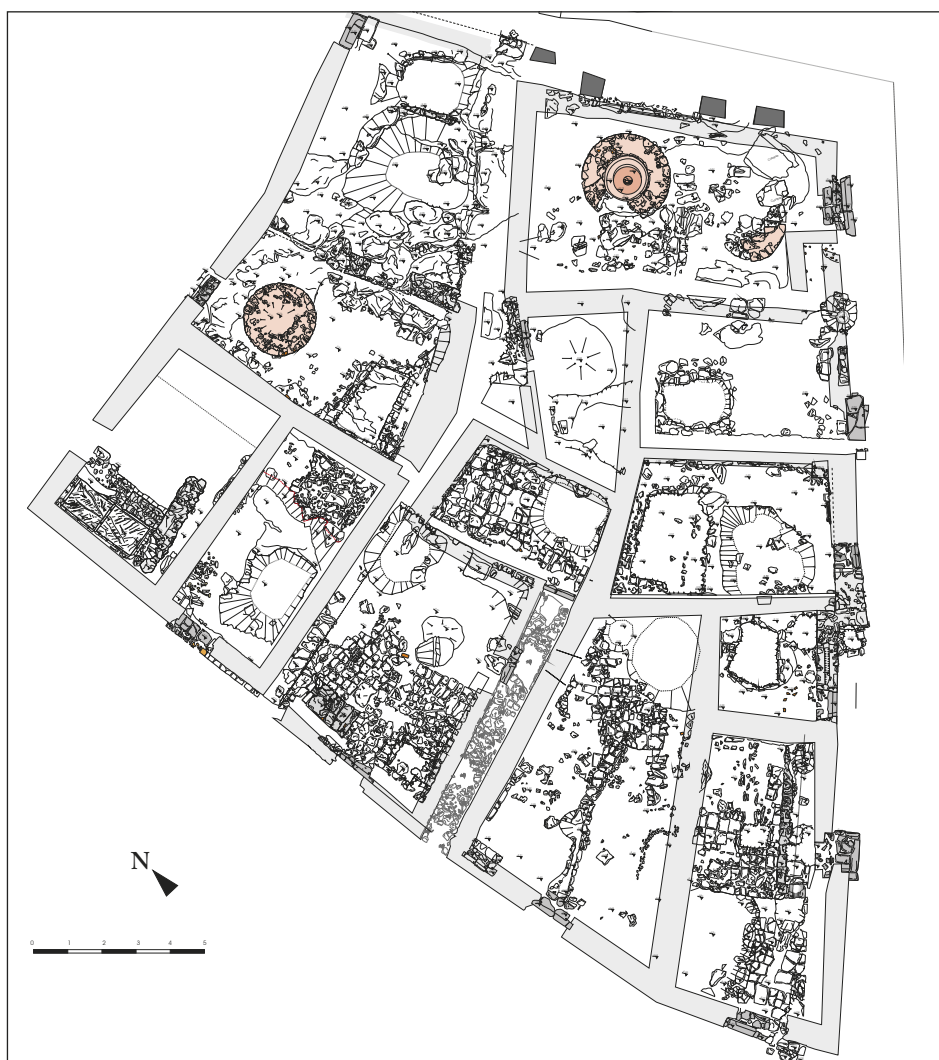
Planimetria dell'isolato 140, stato di fatto.
